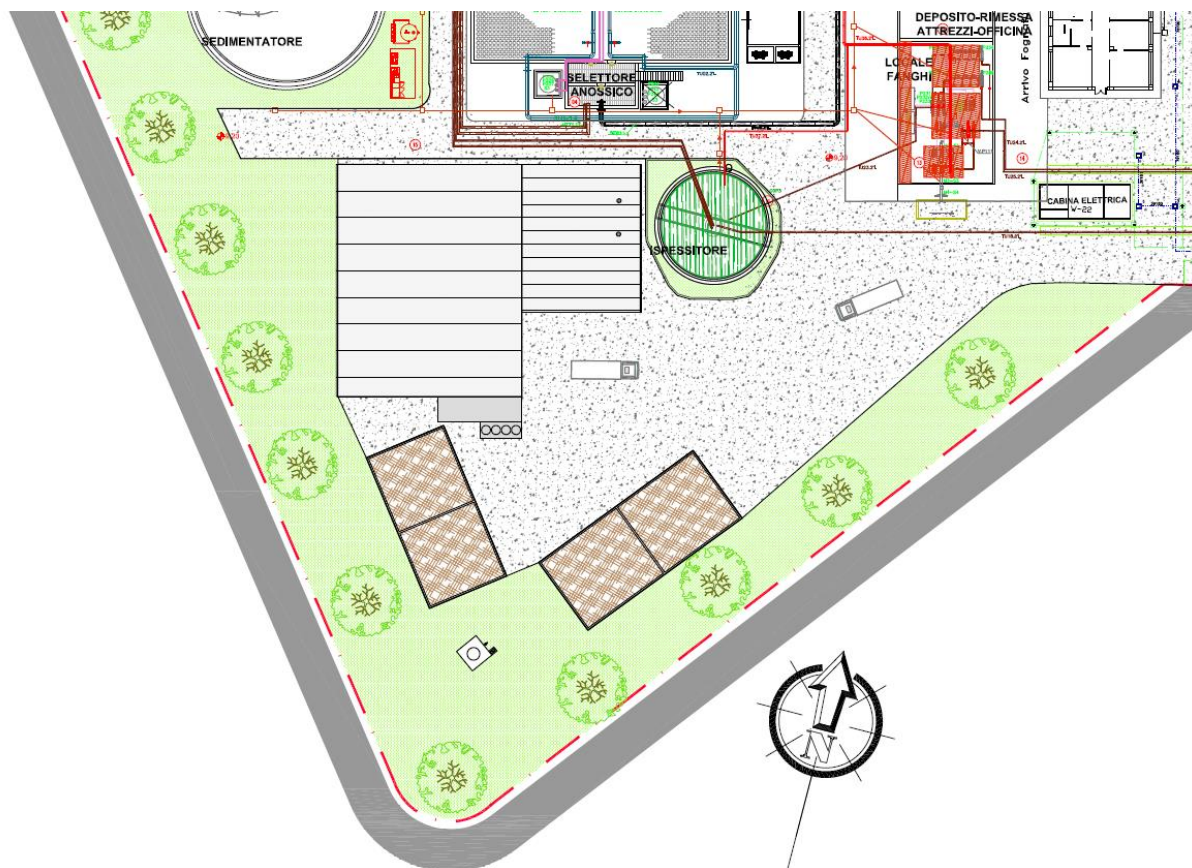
Planimetria della nuova sezione fanghi presso l'impianto di depurazione Basso Tenna CIIP spa
